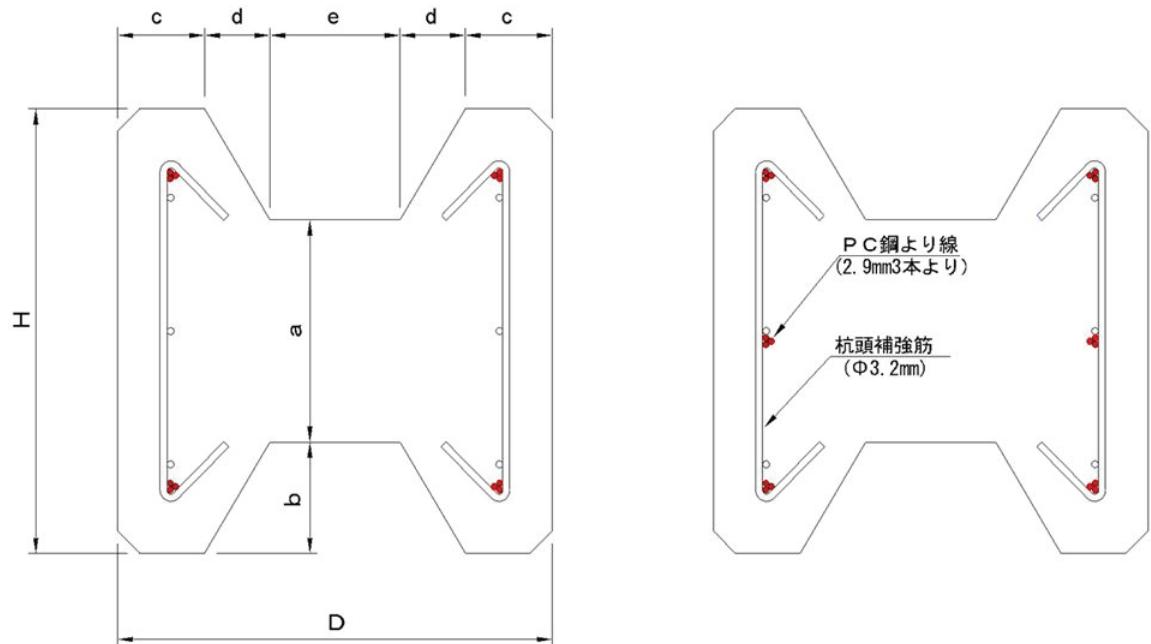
H形コンクリート杭断面図（会澤コンクリート株式会社より）
